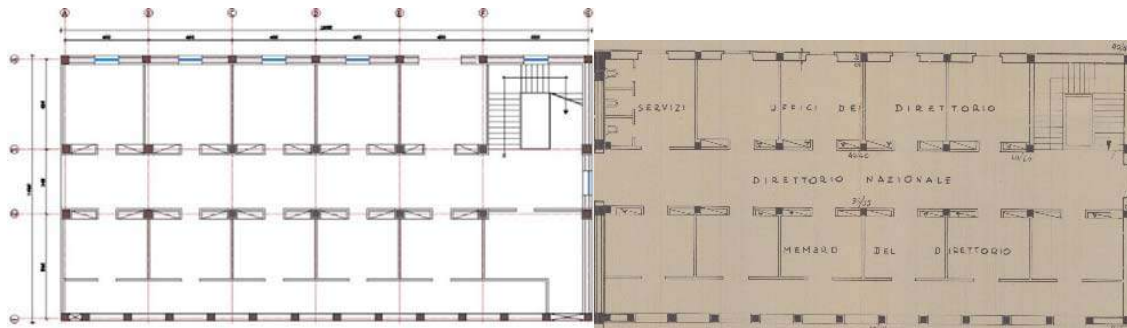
Planimetria e katit të dytë: Majtas planimetria e sotme, Djathtas planimetria nga projekti original
